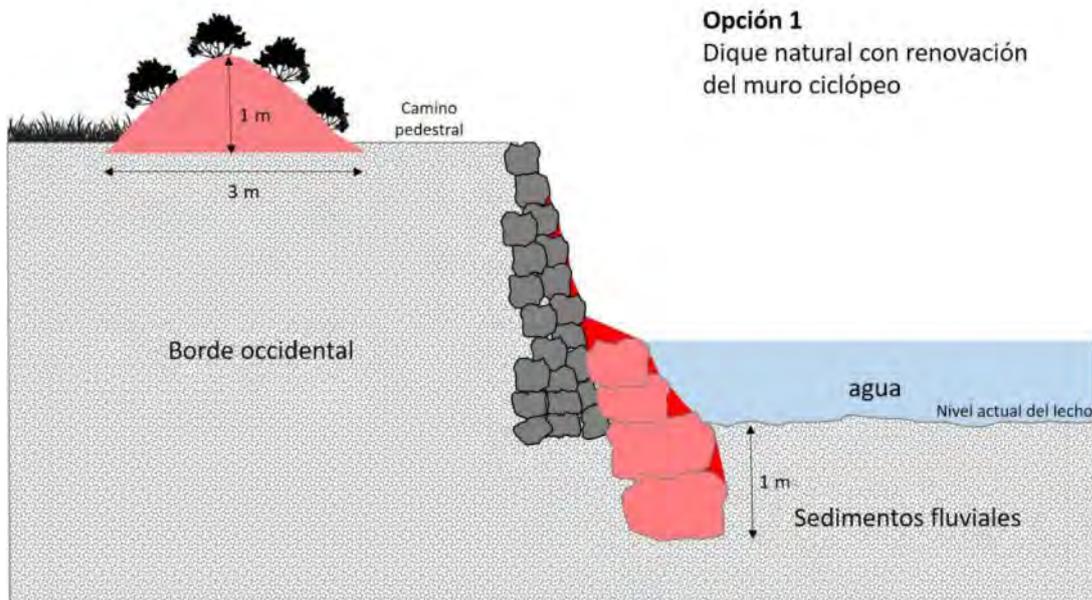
Corte transversal de la quebrada con las medidas propuestas (dique y cimentación del muro de protección, en rojo), aproximadamente a 40 m aguas arriba de la cajapunte. Vista en dirección de flujo.
